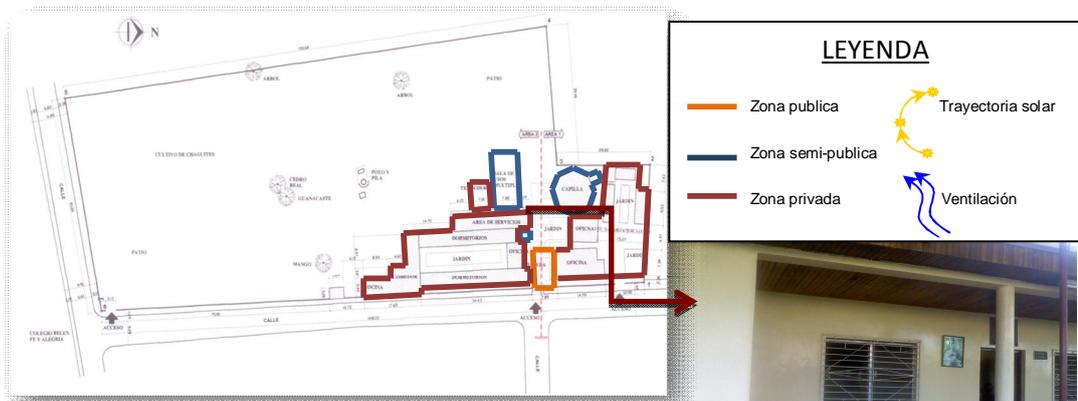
Planta de conjunto del Hogar Santa Lucia./ Fuente: Propia
